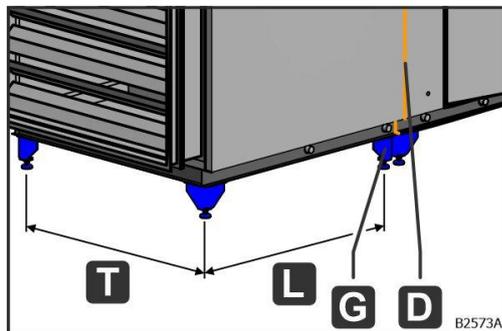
Fondations ponctuelles pour centrales sur châssis DIN (dimensionnement)
